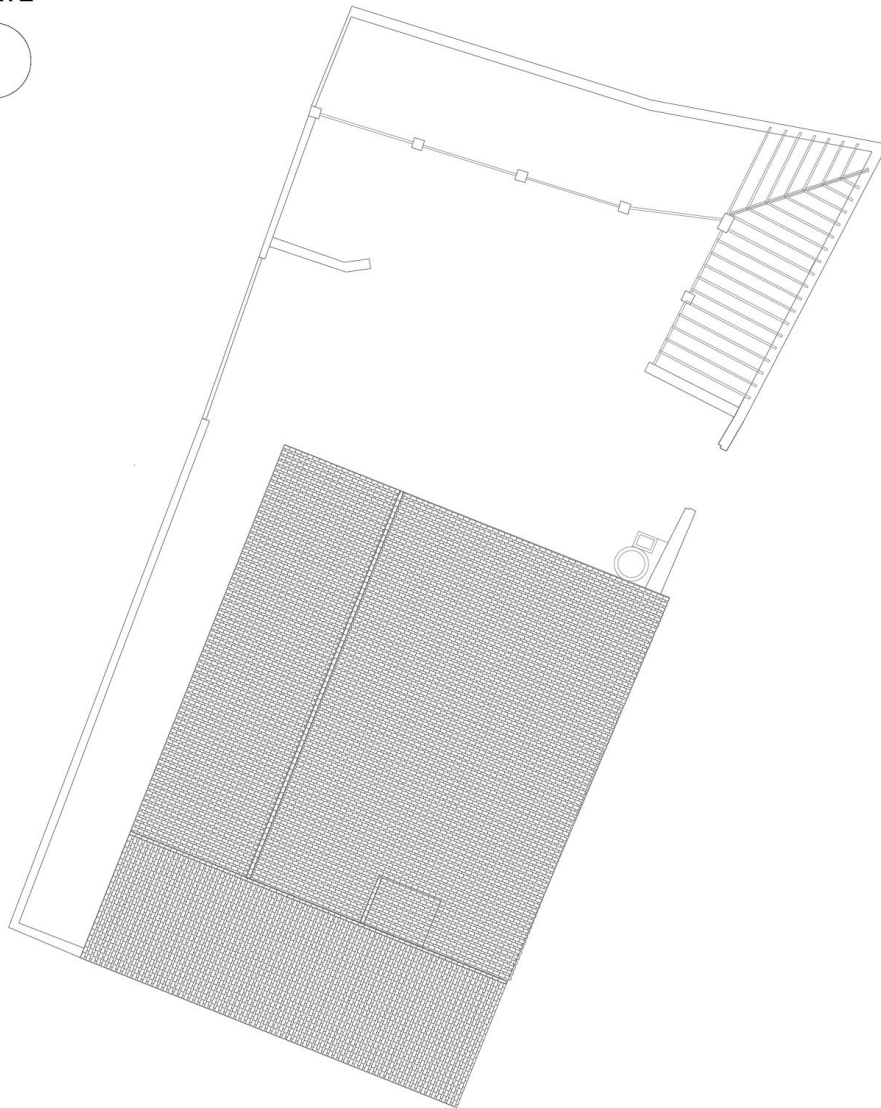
Planta Cubierta del volumen principal de La Alquería del Moro. Escala 1:250. Fuente propia.
